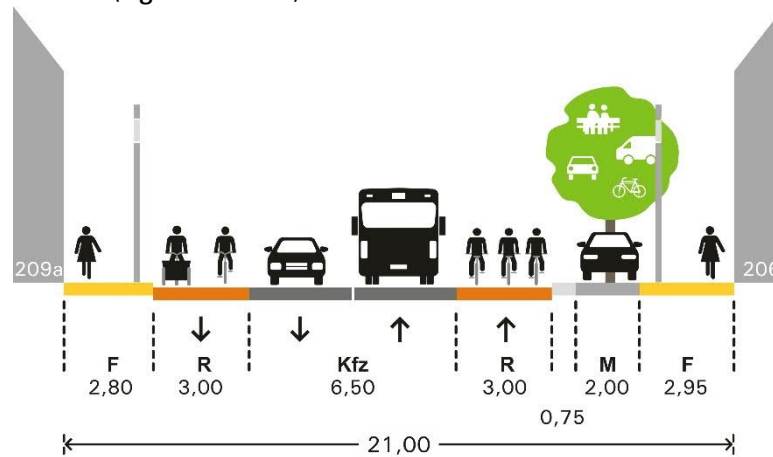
Straßenraumquerschnitt B-B – Variante 2 Veloroute
